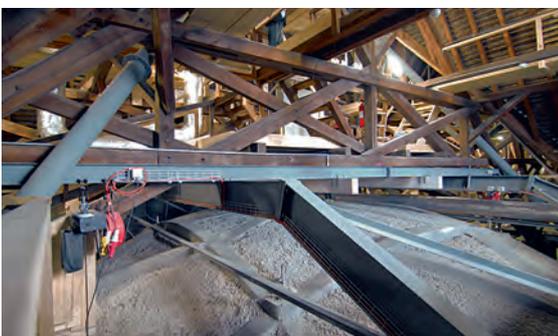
Erdbebensicherung der beiden Giebelwände der Ruhmeshalle aus Mauerwerk mittels Stahlfachwerk.
